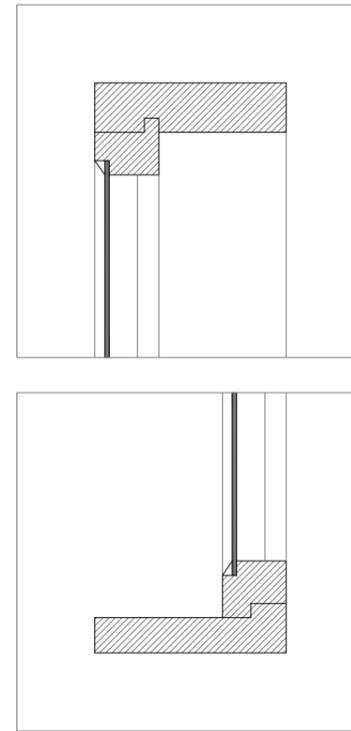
Perfil de Caixilharia Existente da Parede-cortina | Escala 1:5
